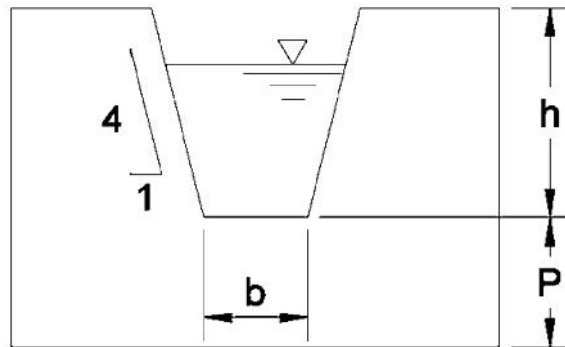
Vertedero Trapezoidal Cipolletti.
